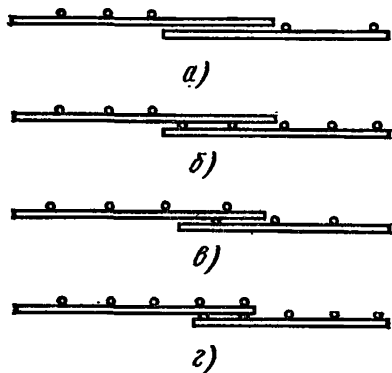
Налесточные соединения сеток без сварки в направлении арматуры периодического профиля: а — без анкерирующих поперечных стержней на двух сетках, б — без анкерирующих стержней на одной из сеток, в — при одном анкерирующем стержне, г — при двух анкерирующих стержнях
